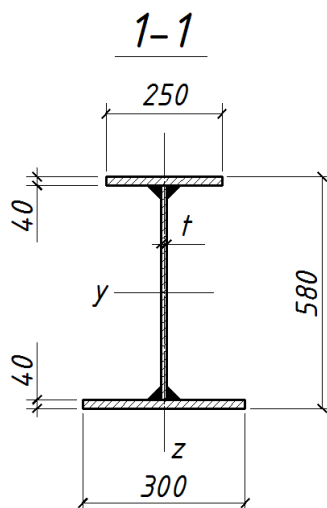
Поперечное сечение сварной однопролетной балки
